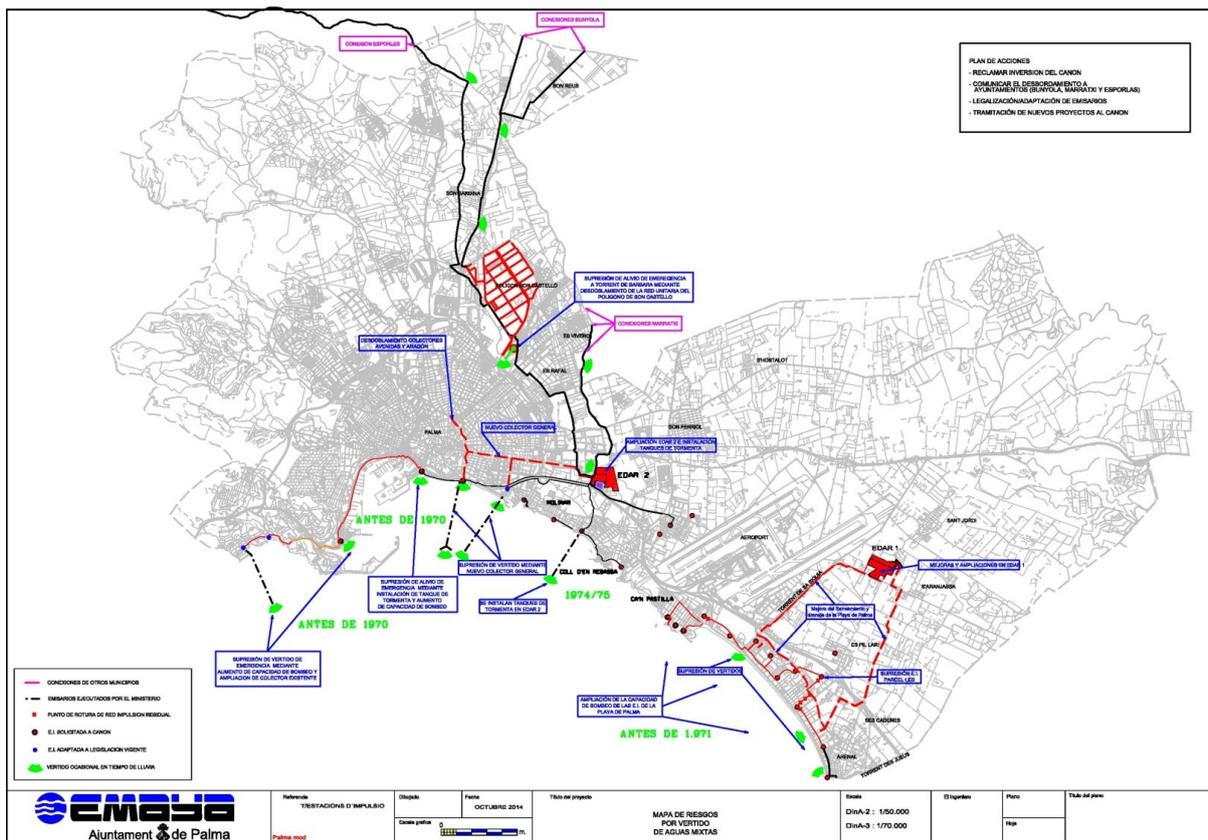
Obras previstas en el Plan Director de saneamiento de la Bahía de Palma
